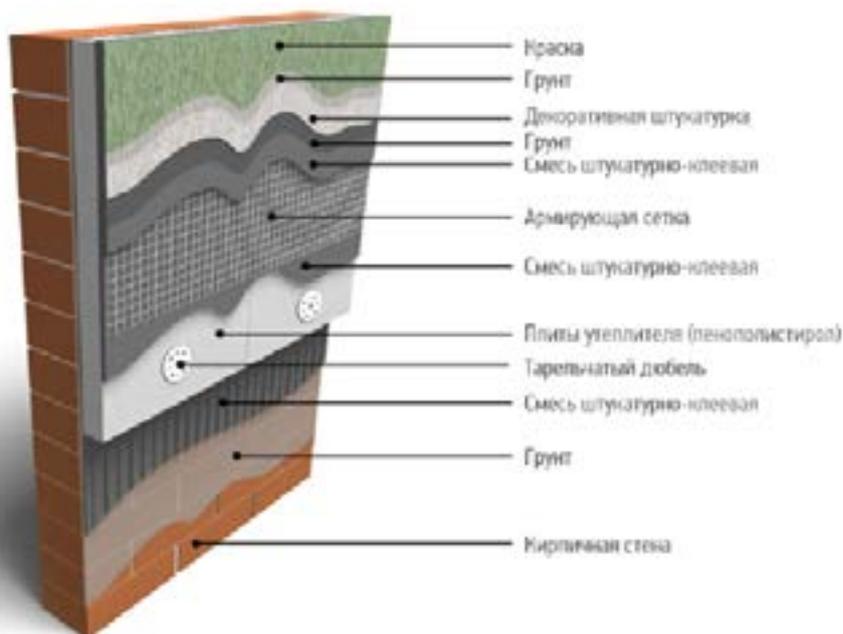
Схематичный разрез системы утепления «мокрый фасад»
